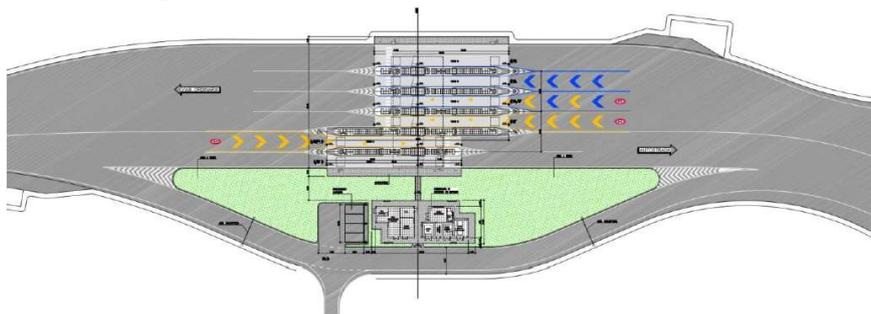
Stralcio planimetrico del piazzale di esazione di Toscanella di Dozza
